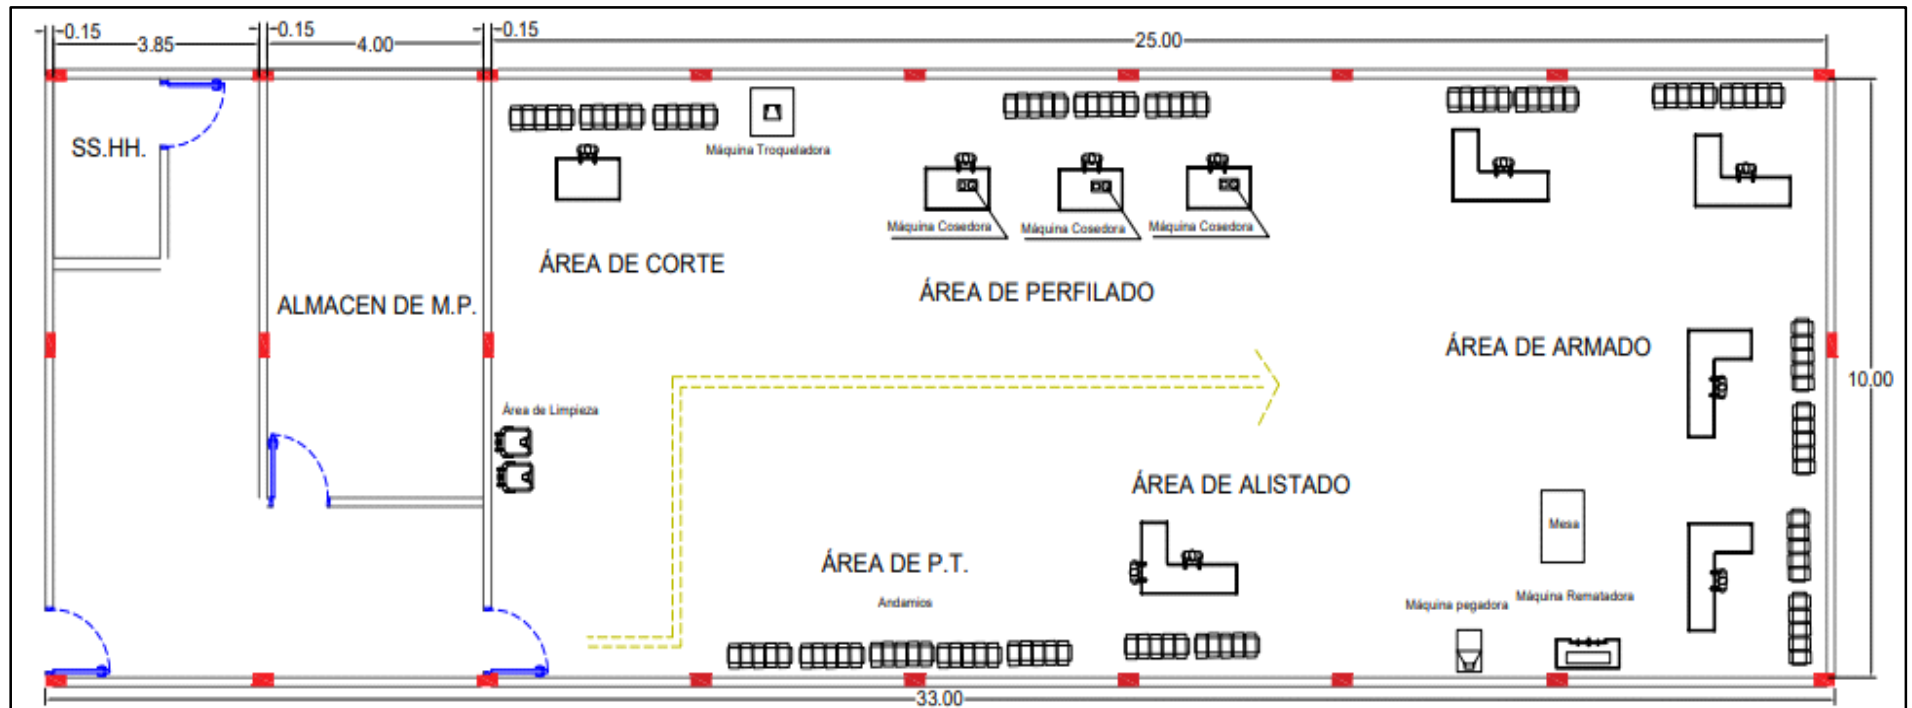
Distribución de Planta del Área de Producción – Propuesto- Calzados Lantana
